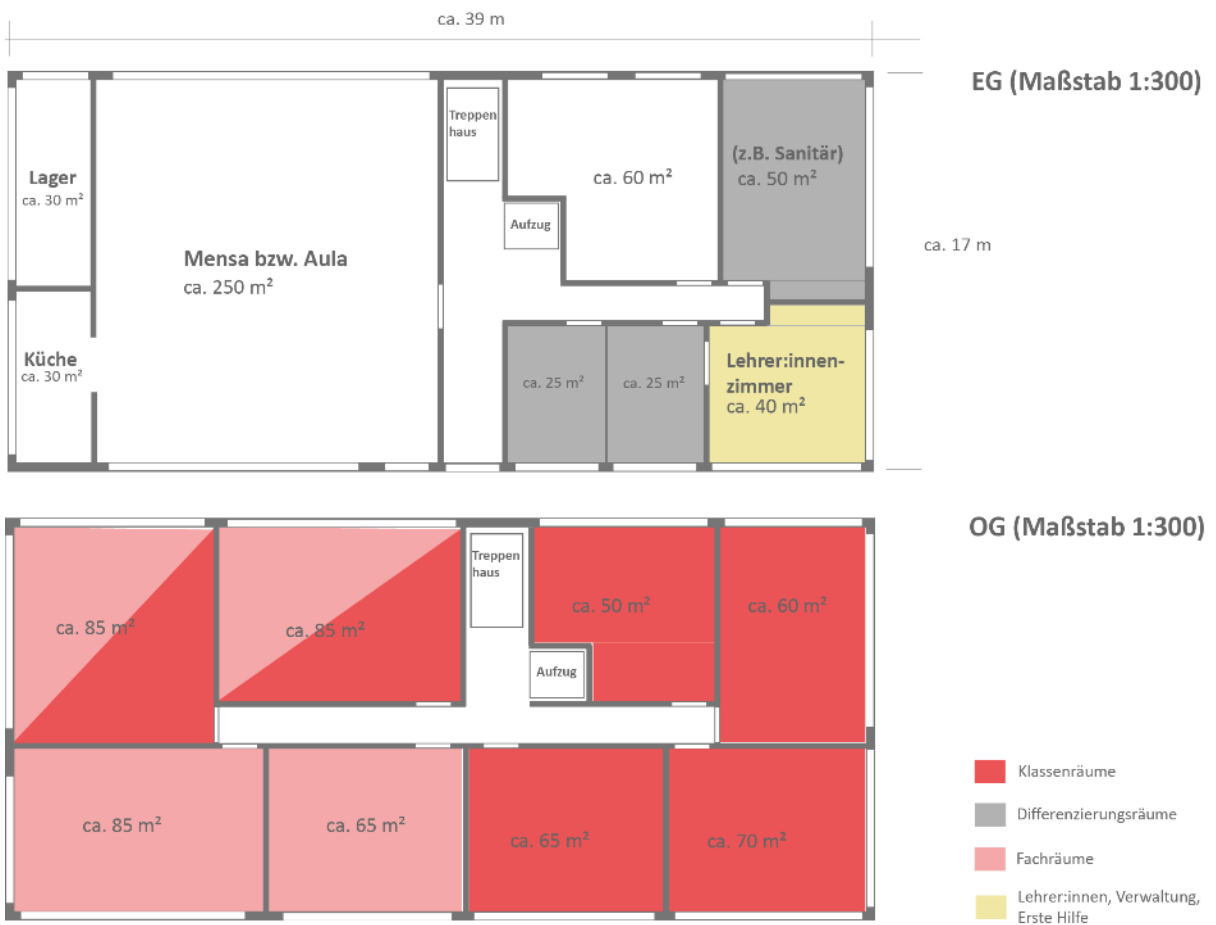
Grundrissvariante 2 für den zweigeschossigen Neubau einer Mensa/ Aula
